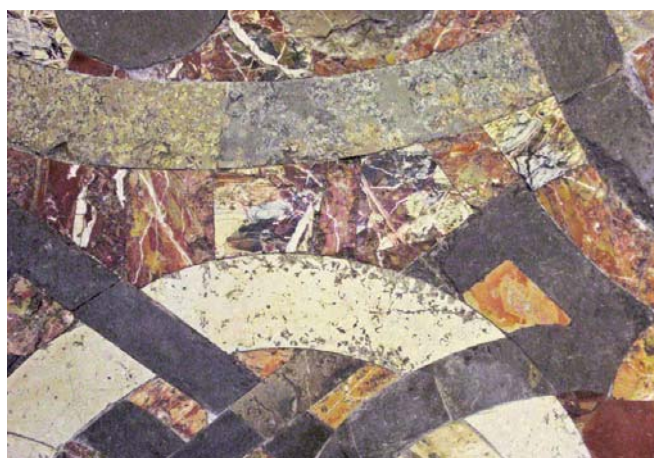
Trapani. Chiesa di Santa Maria del Soccorso, particolare della pavimentazione.
